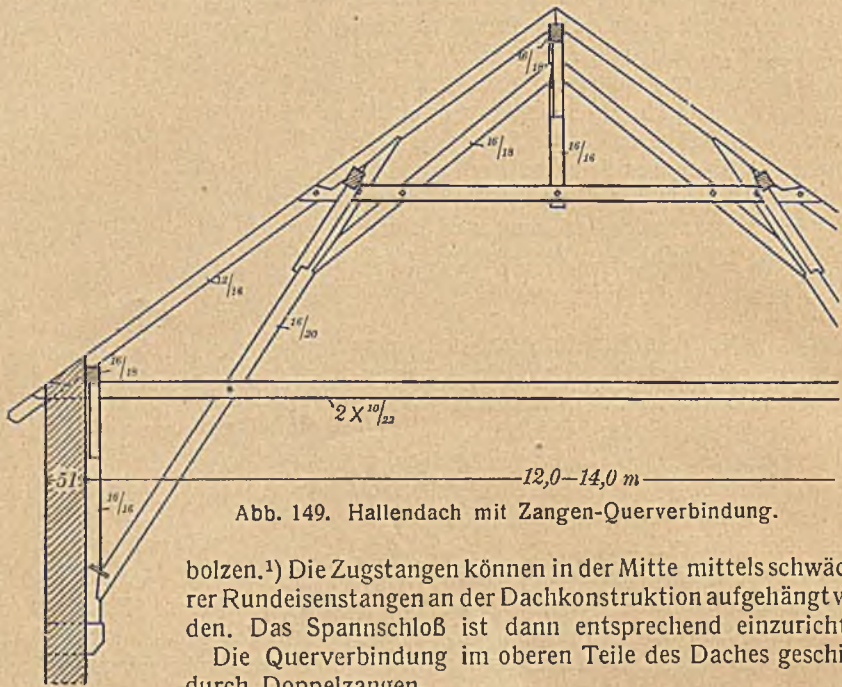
Hallendach mit Zangen-Quer Verbindung.
